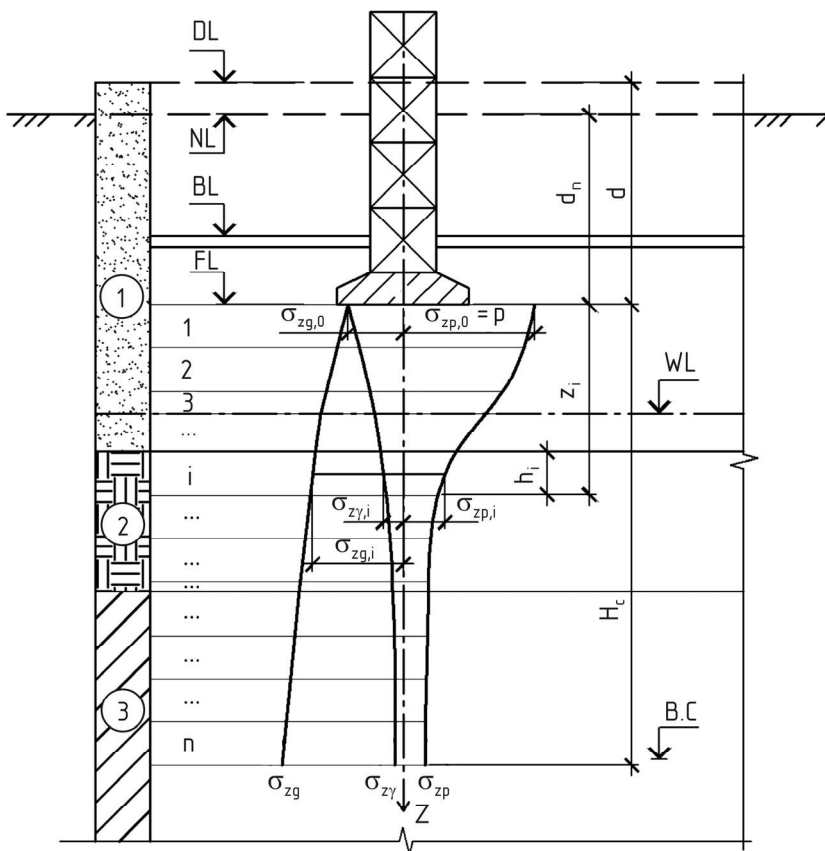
Схема для расчета осадки методом послойного суммирования
